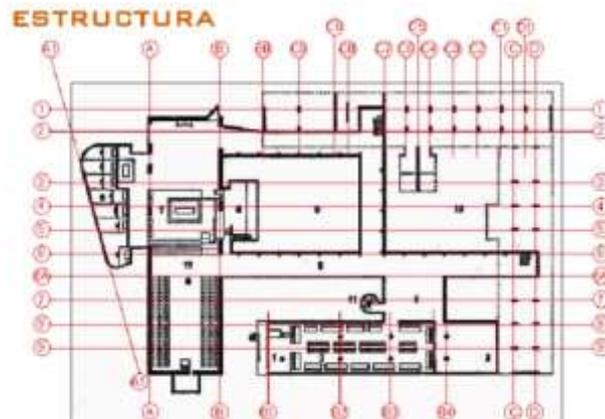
Esquema Estructural La Tourette. Elaboración propia.
